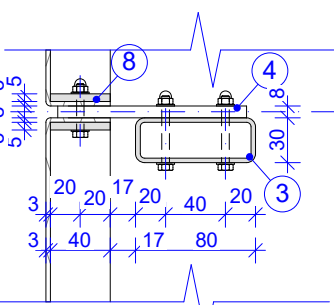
DETAIL KOTVENÍ DO KONSTRUKCE, M 1:5
